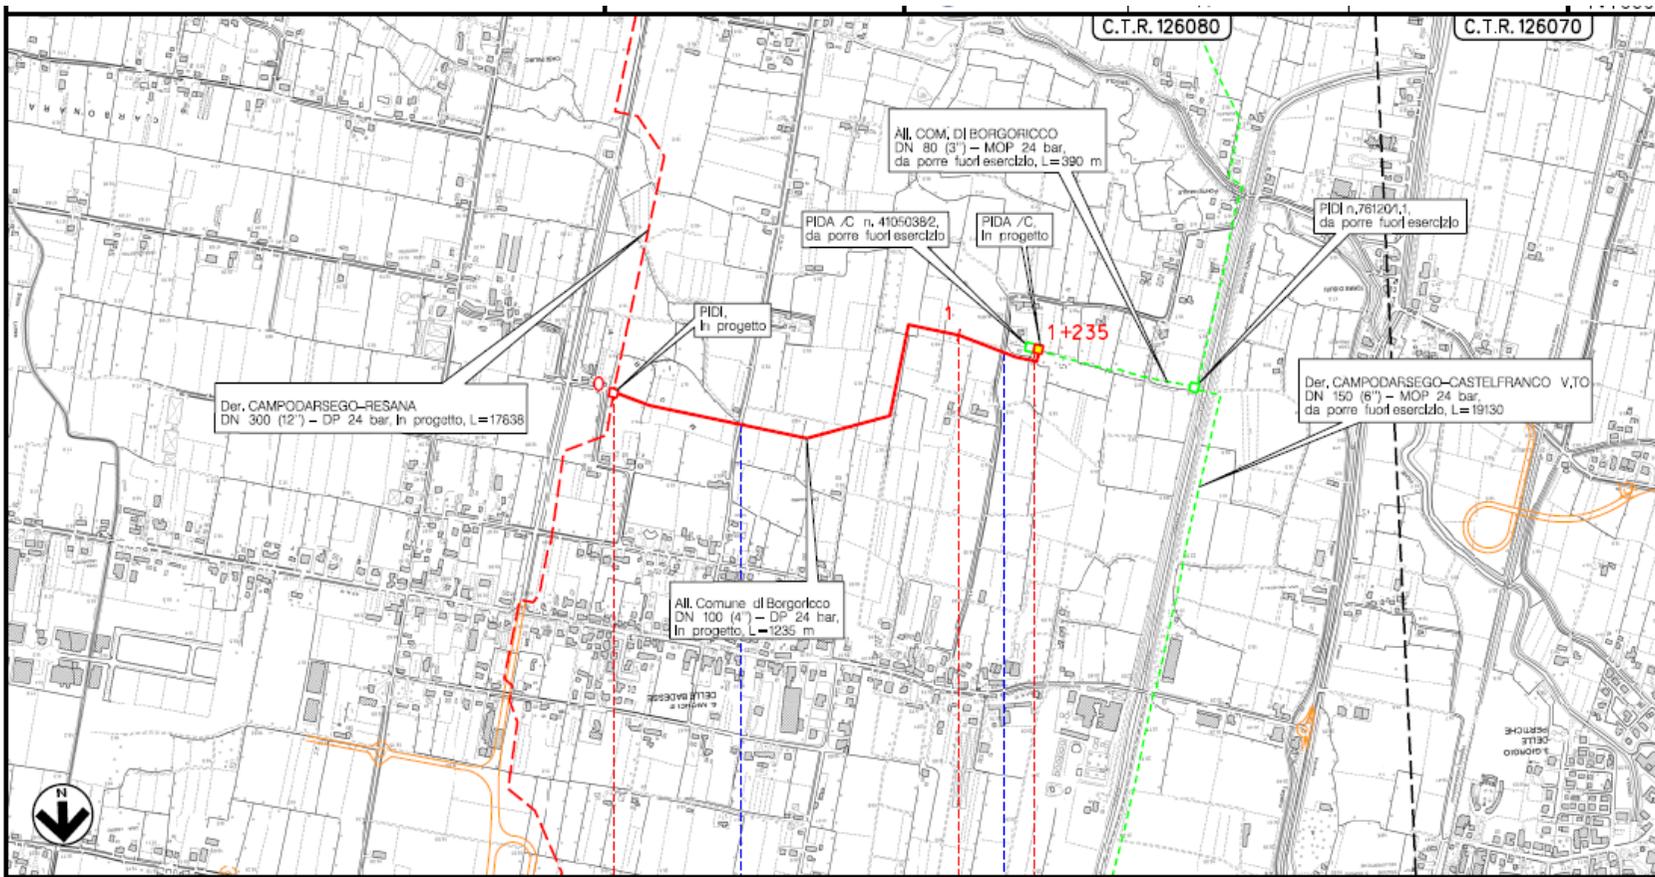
RIF. ALL. Comune di Borgoricco - Stralcio planimetria CTR con localizzazione dell'area di intervento
